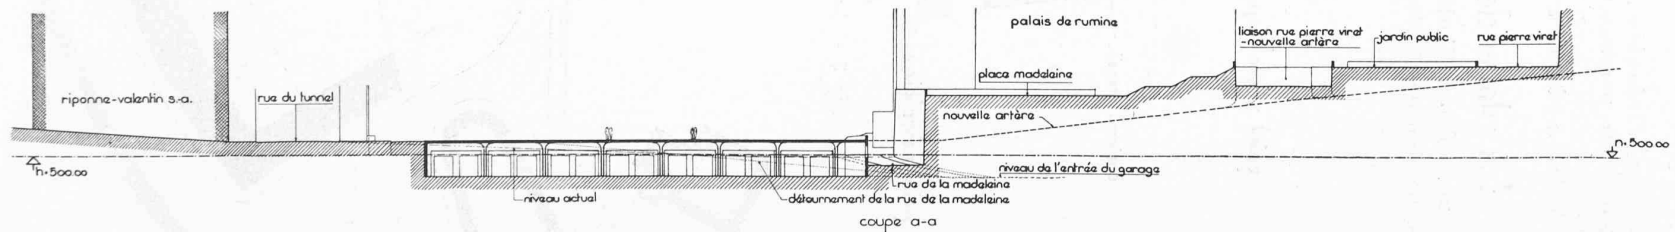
Coupe a-a (voir plan). — Echelle 1 : 1000.
